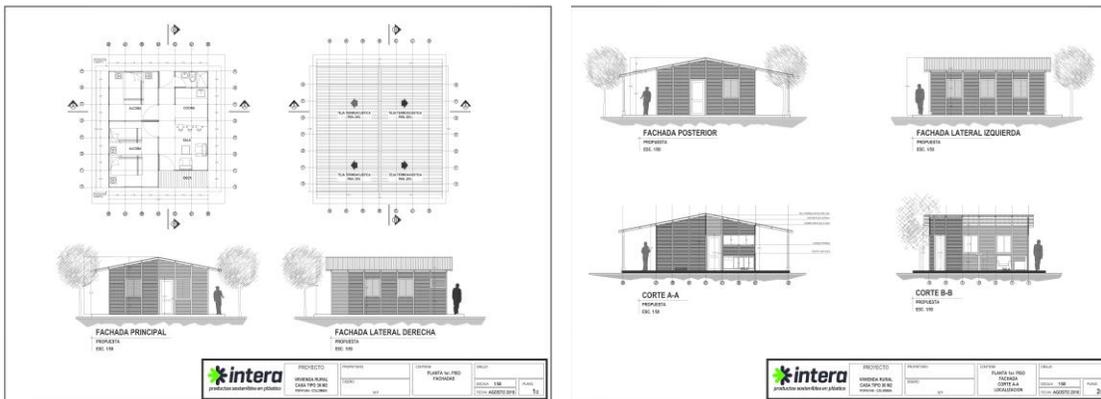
Planta Distribución Vivienda Rural 42 m<sup>2</sup> Sin Corredor. Fuente: Elaboración propia.
